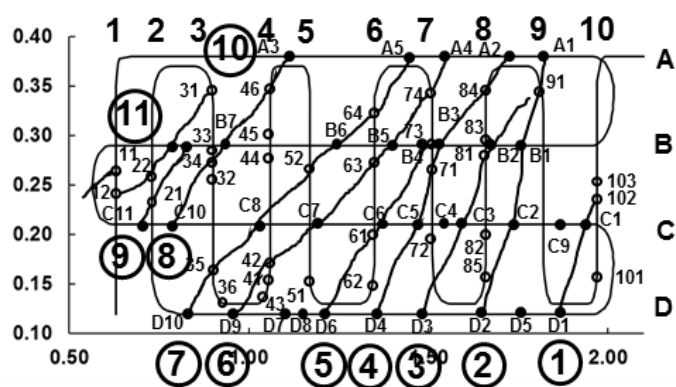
Identificación de fisuras que conforman el patrón de fisuración de la viga I-2
